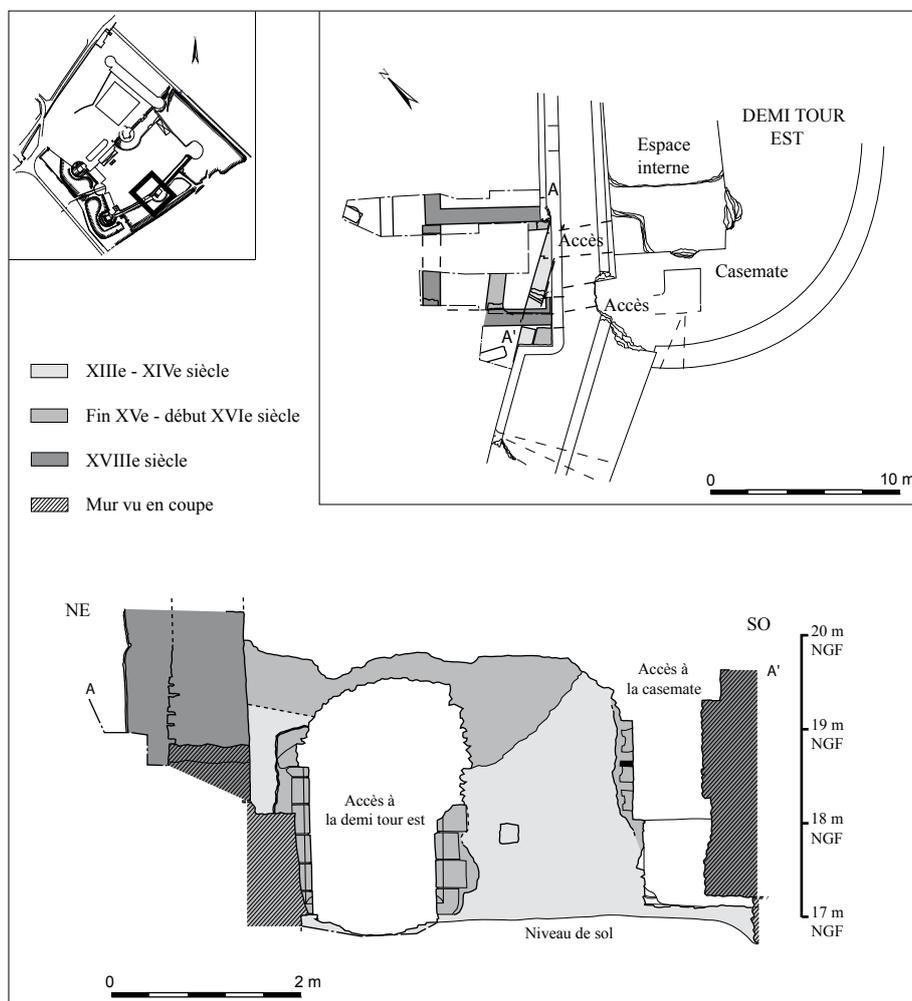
Blain, sondage 5, plan et relevé de la façade interne orientale (DAO Patrick Bellanger).
